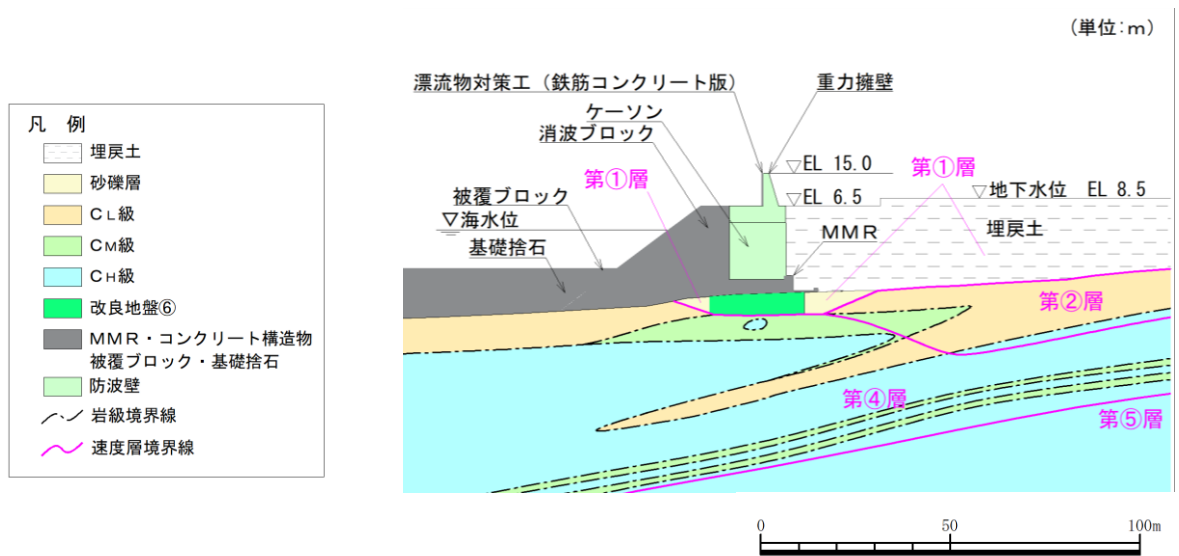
(2) 地質断面図 (防波壁 (波返重力擁壁) ②-②断面)
